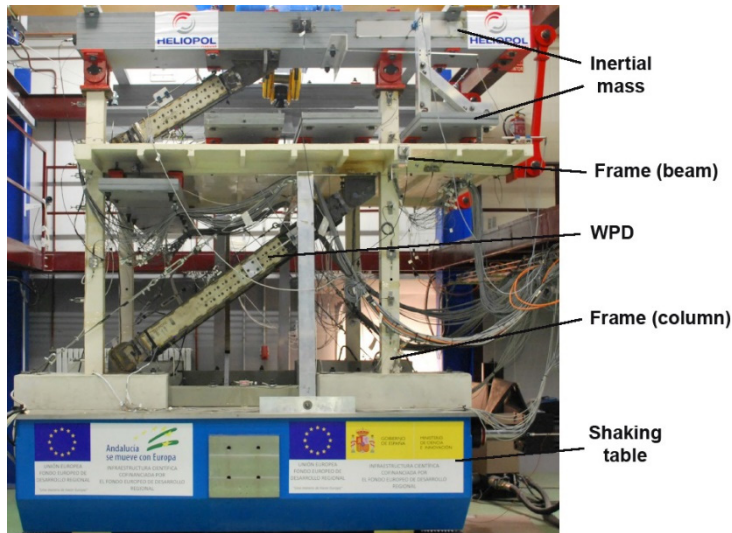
Vista general del espécimen FD colocado en la mesa sísmica.
